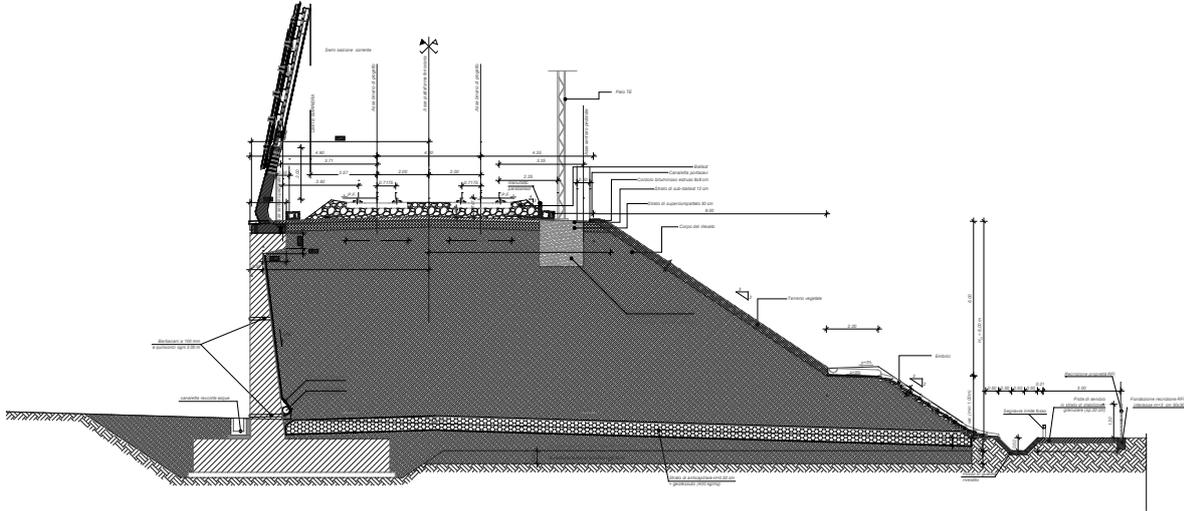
Sezione tipo ferroviaria in rilevato con opera di sostegno con BA tipo “HS”
